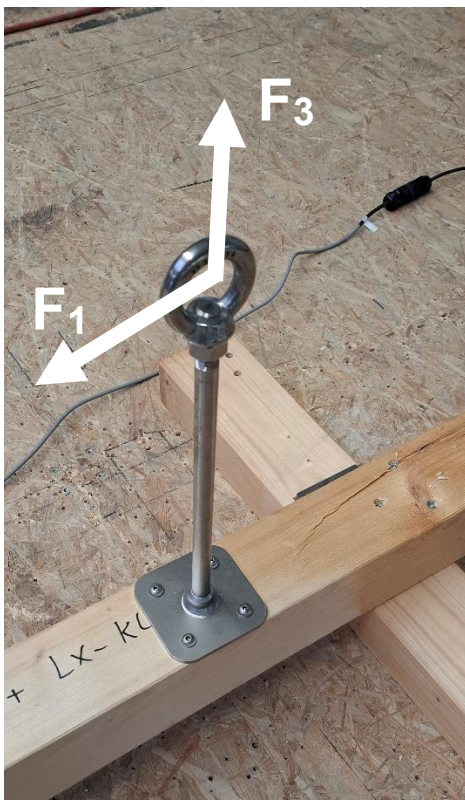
Prüfaufbau 7, Anschlagereinrichtung,
